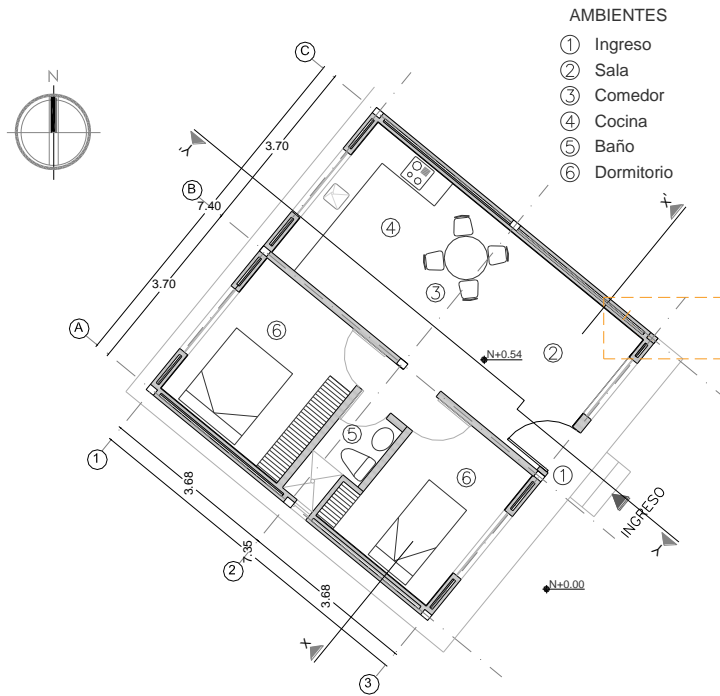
Vivienda existente Huambaló Centro / diseño del muro perimetral con aislante térmico.
